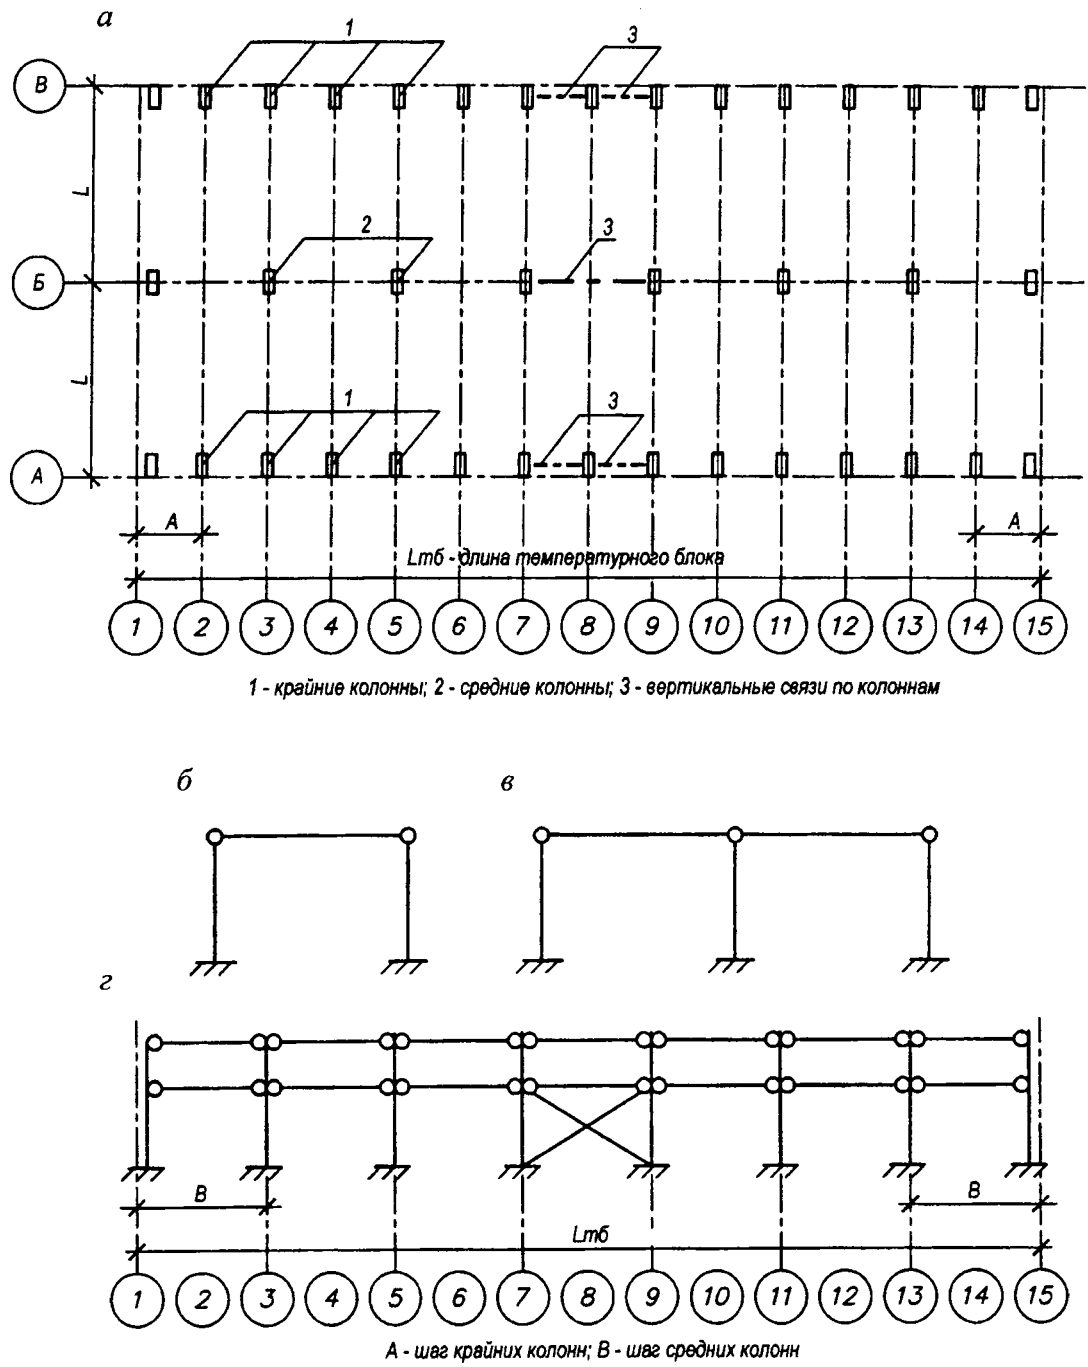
Конструктивная схема каркаса одноэтажного промышленного здания:
